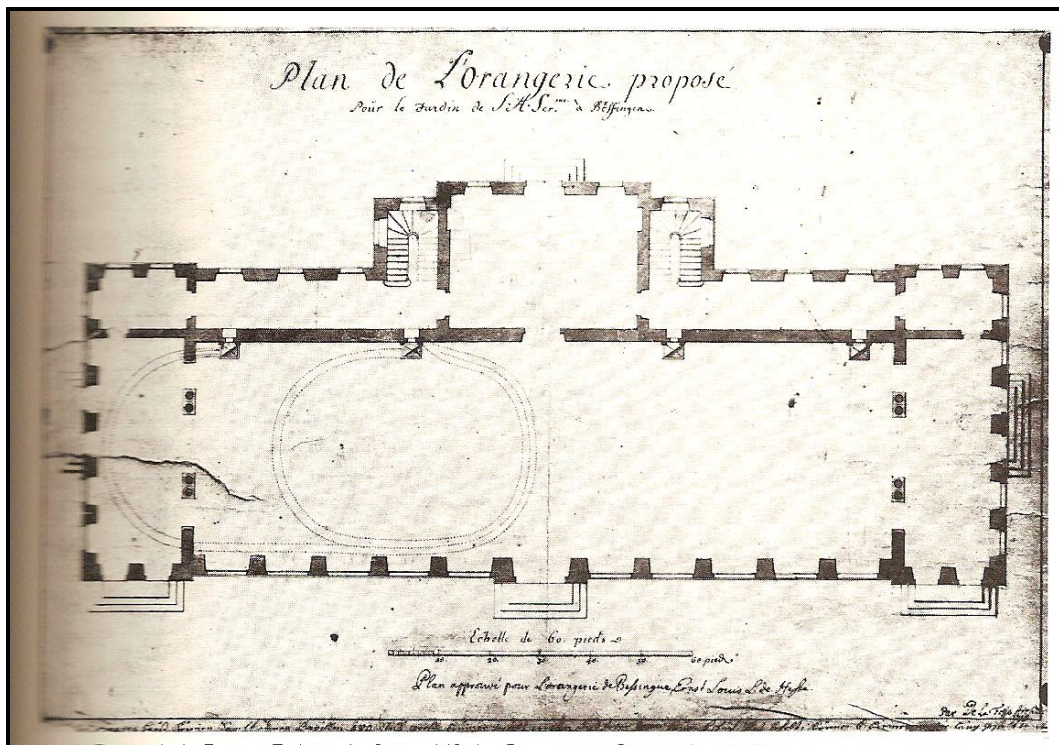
Erdgeschossgrundriss der Bessunger Orangerie, 1719
